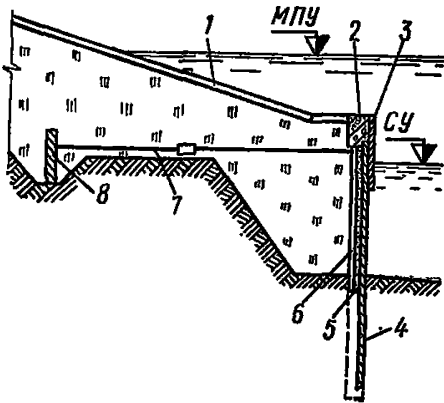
Стенка из железобетонного шпунта таврового сечения анкеранная (или со свободным концом)
